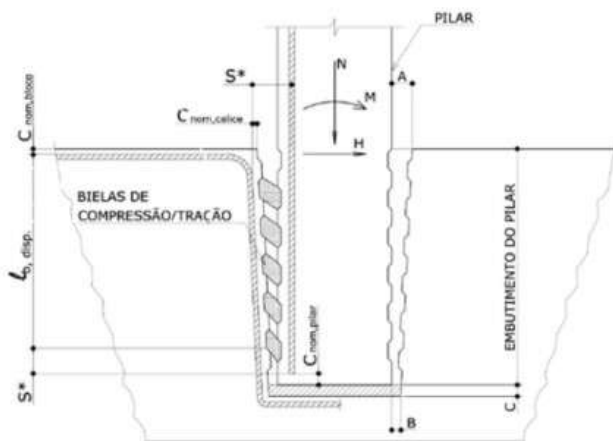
Esquema geral do funcionamento do traspasse das armaduras, na ligação pilar/fundação
